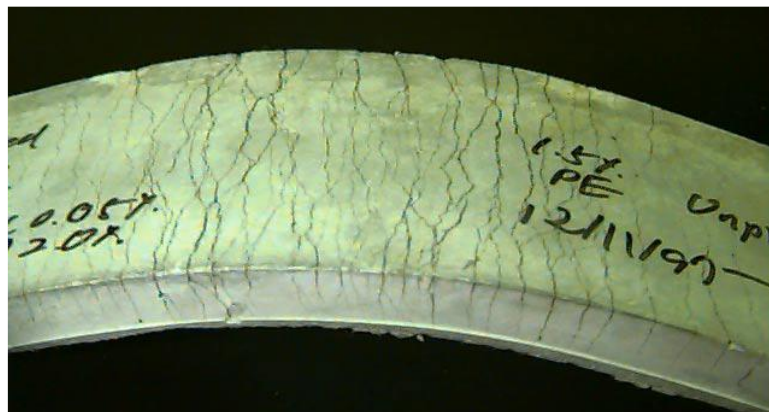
Aspecto de fissuração de um compósito cimentício de elevada deformação. Fonte: Li e Kanda (1998).
